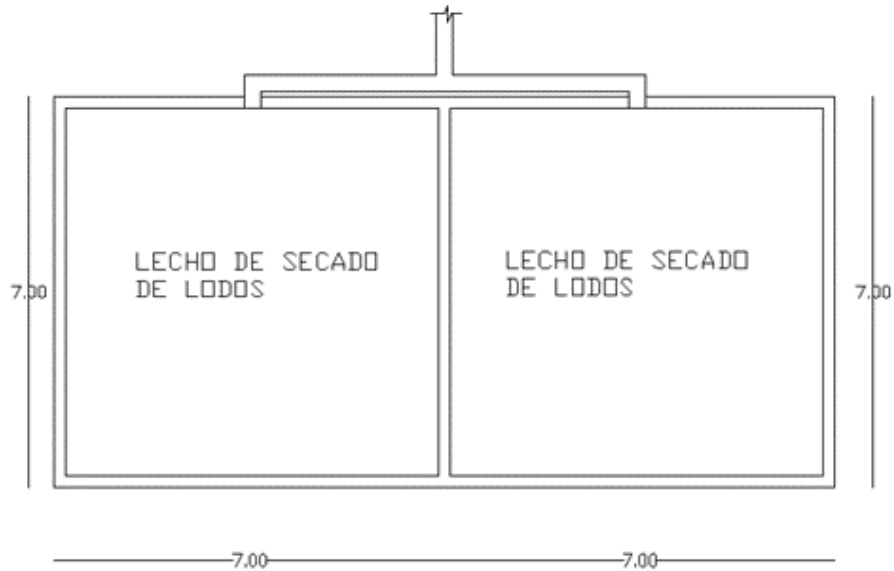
a) Vista en planta de lecho de secado de lodos
